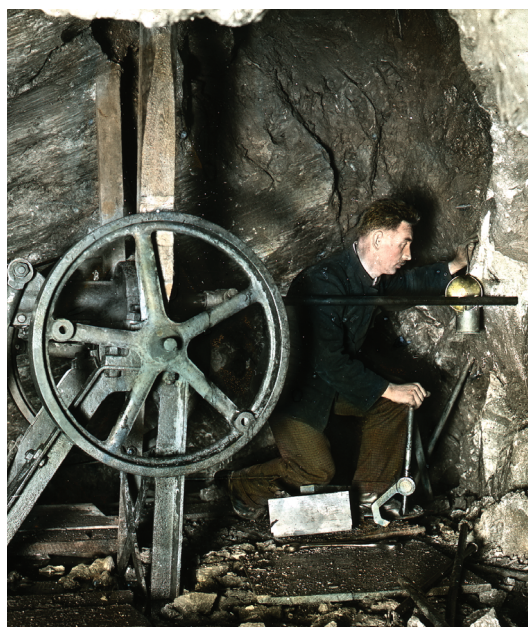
(57-040) Agregát před výtokem Punkvy.
